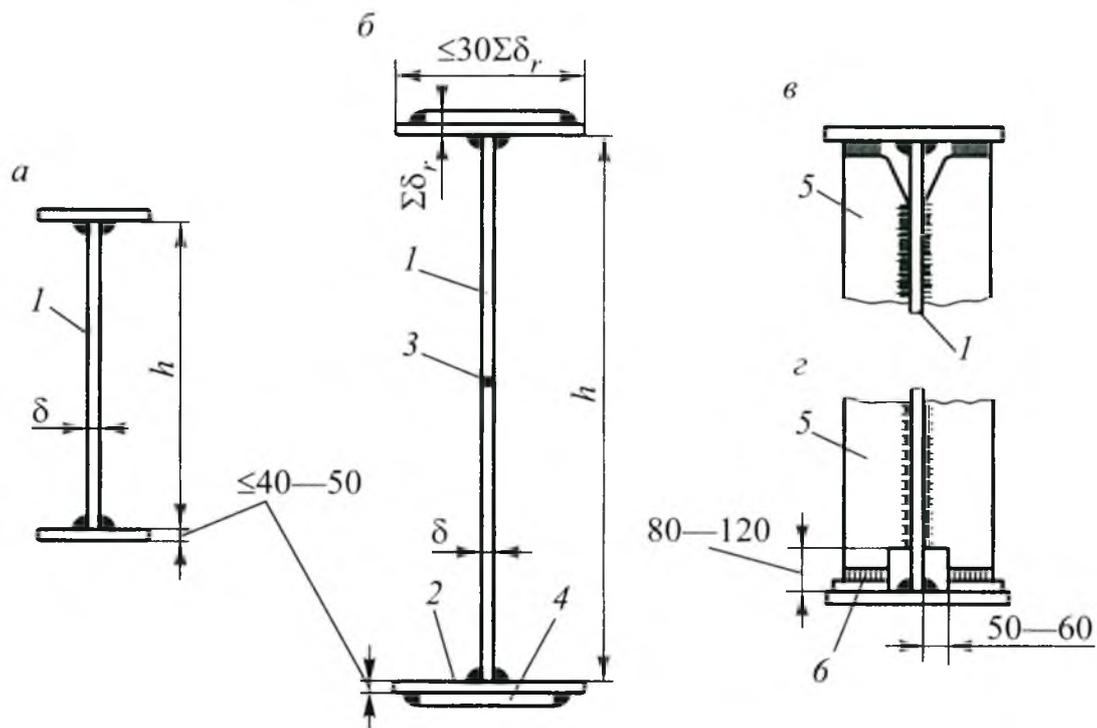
Конструкция сварных двутавровых балок:
